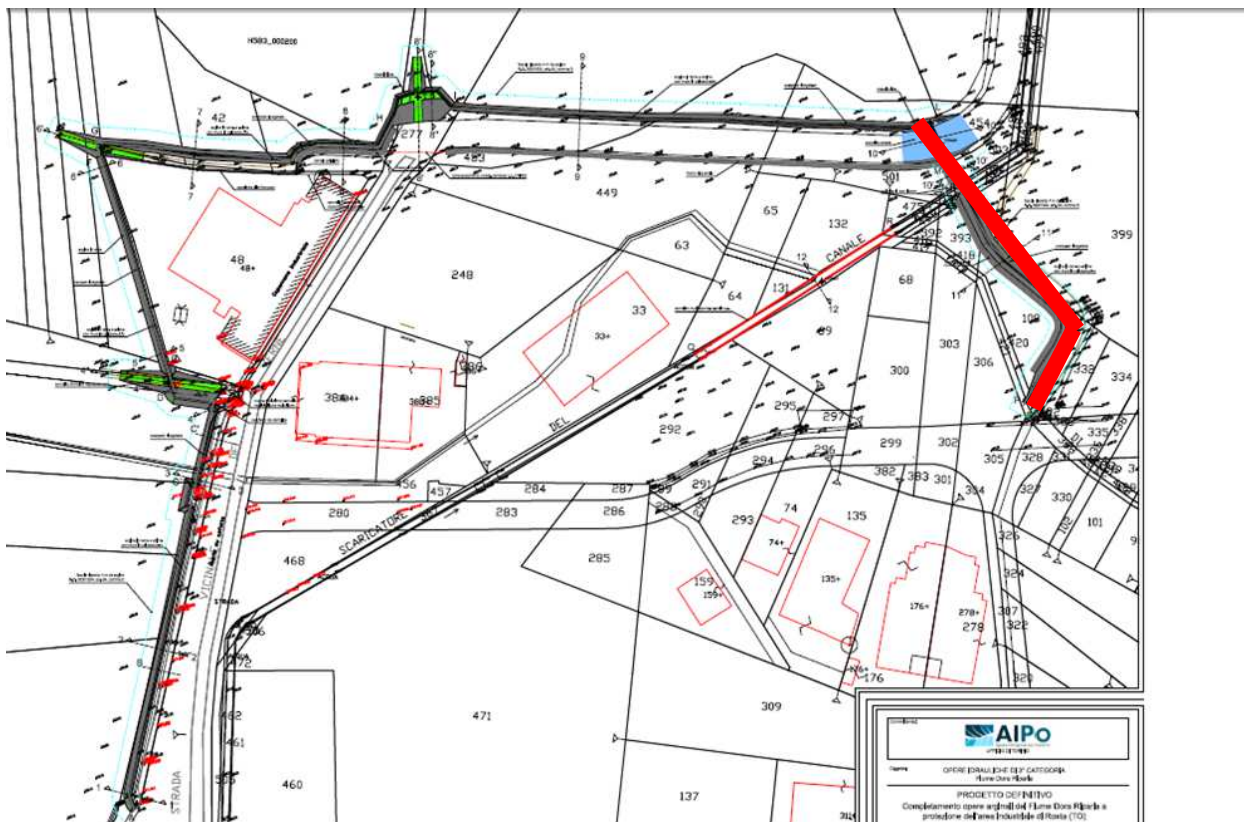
Planimetria del progetto; in rosso il tratto L – P
